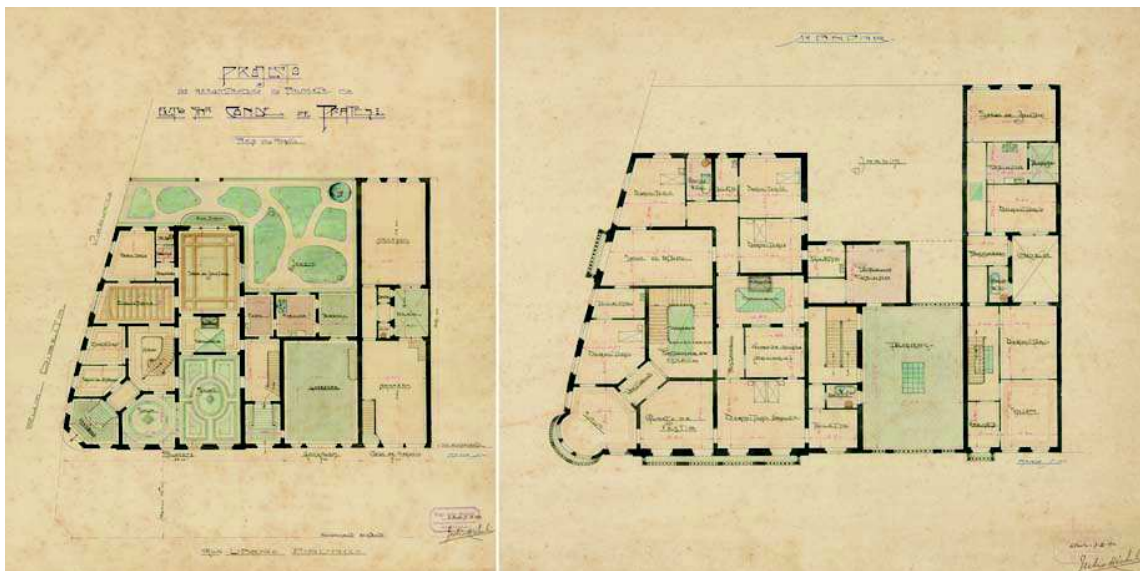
Giulio Micheli - Palacete Conde Prates, na Rua Direita esquina com Rua Libero Badaró - reconstrução (1911). Pavimento térreo e primeiro andar.
